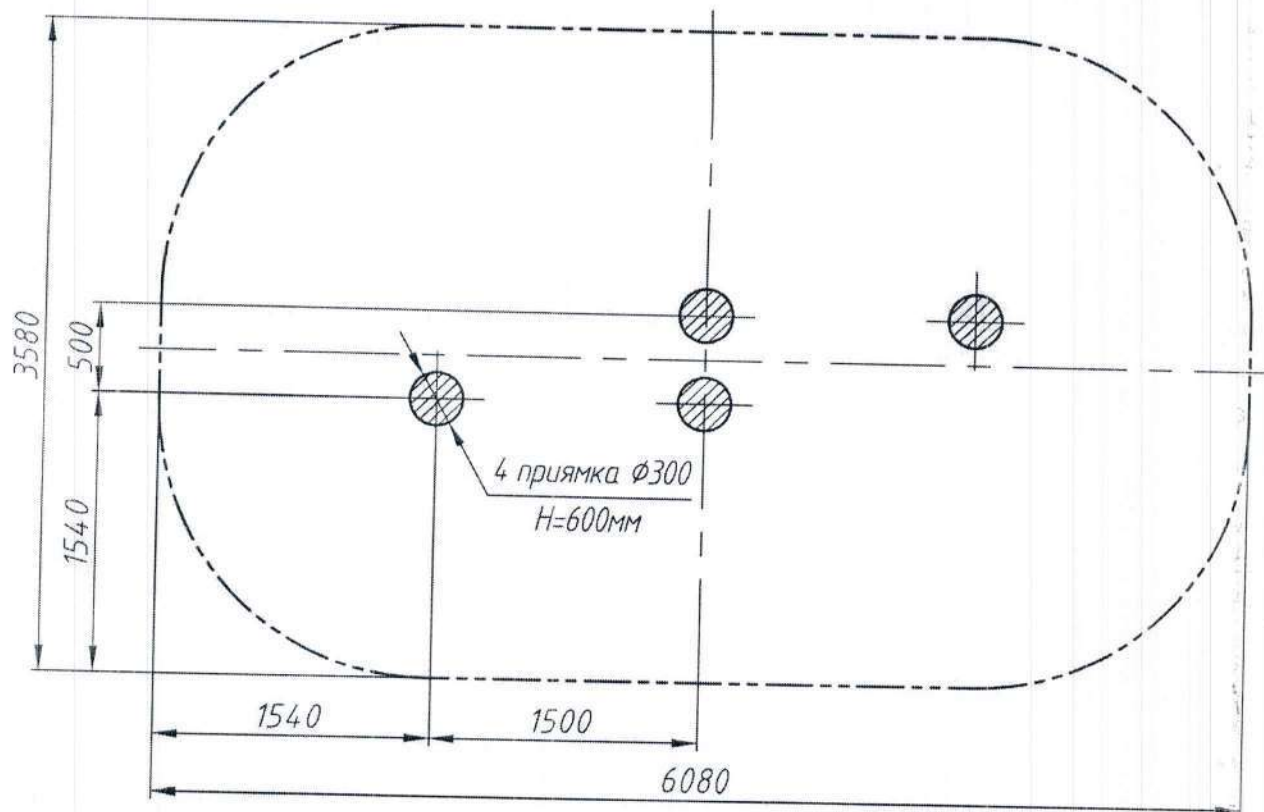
План фундамента Шведской стенки двойной РТР 729С
